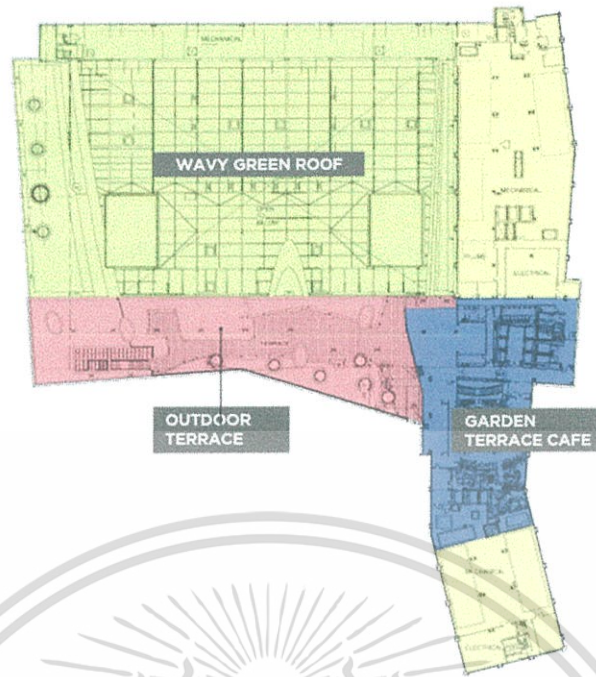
แสดงผังพื้นชั้น 1 Palomar Medical Center West
